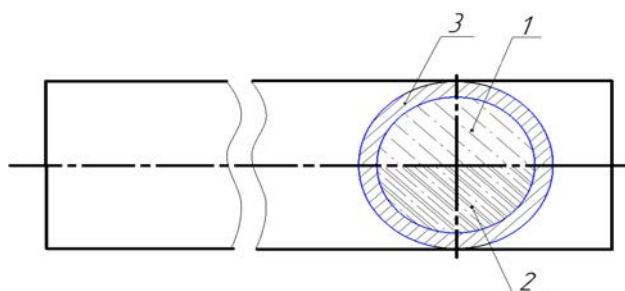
Прямая трубобетонная балка с асимметрично предварительно напряженным бетонным ядром; 1 – бетон (не армированная часть бетонного ядра); 2 – предварительно напряженный железобетон (армированная часть бетонного ядра); 3 – старогодная нефтегазовая труба
